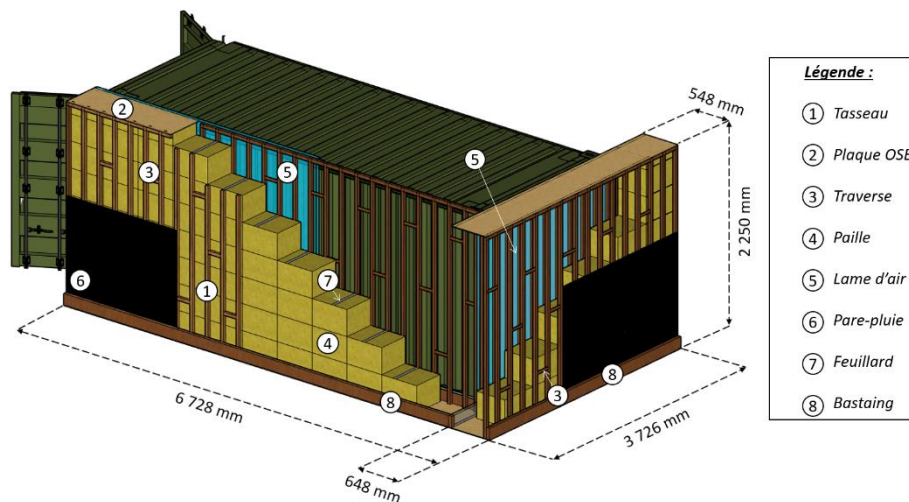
Coupe de deux façades du conteneur isolées en paille
